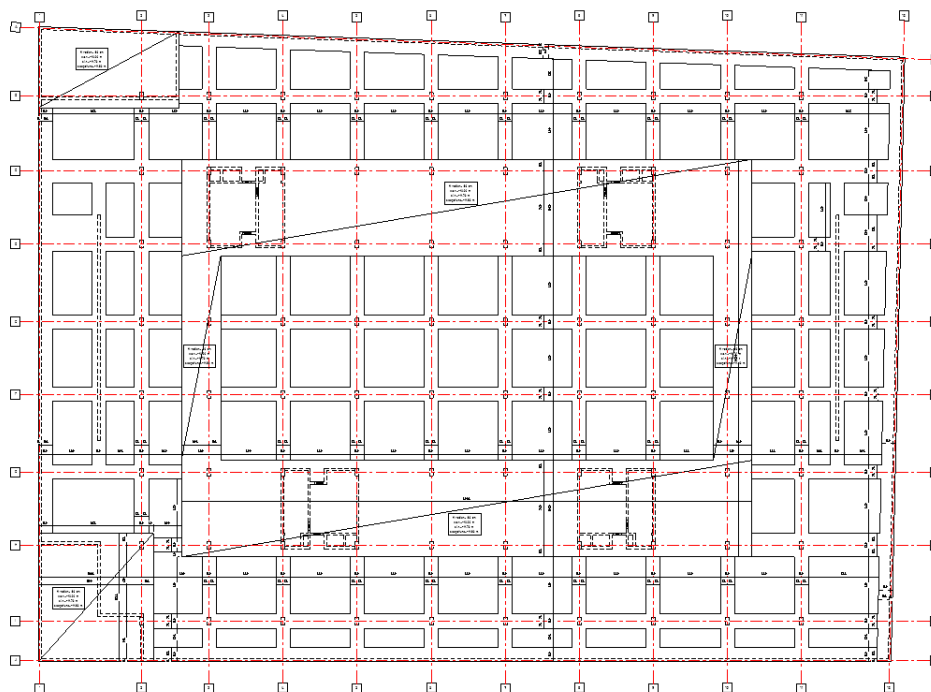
Plan cofraj fundații (Scenariul 1 – Sistem de fundare parcare)
